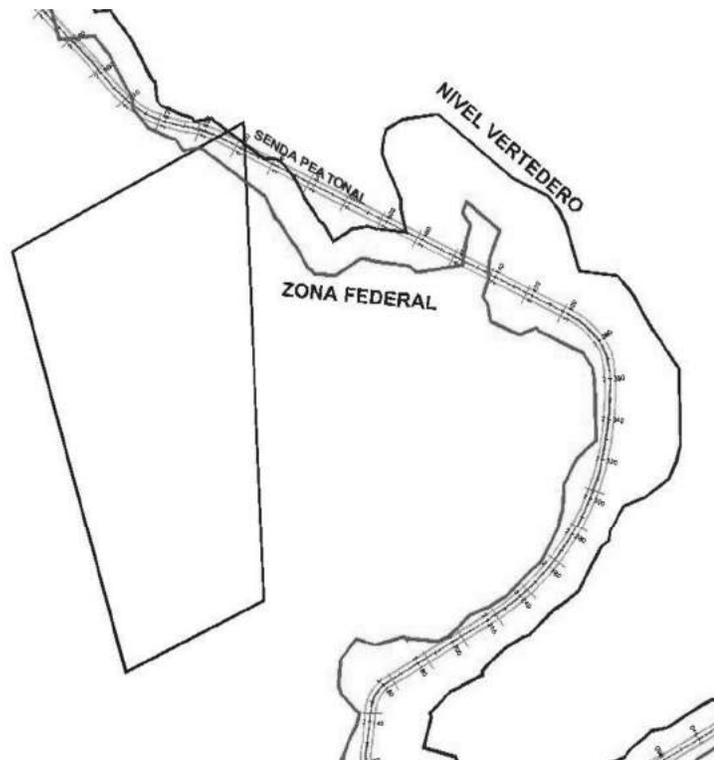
Zona Federal colindando con el área de aplicación. Fuente. Proyecto Parque Metropolitano El Rejón.
